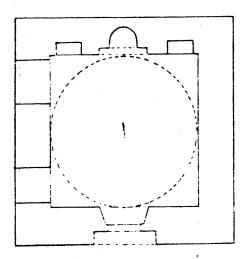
مسقط أفقى لمدرسة وقبة تغرى بردى عن كلر
